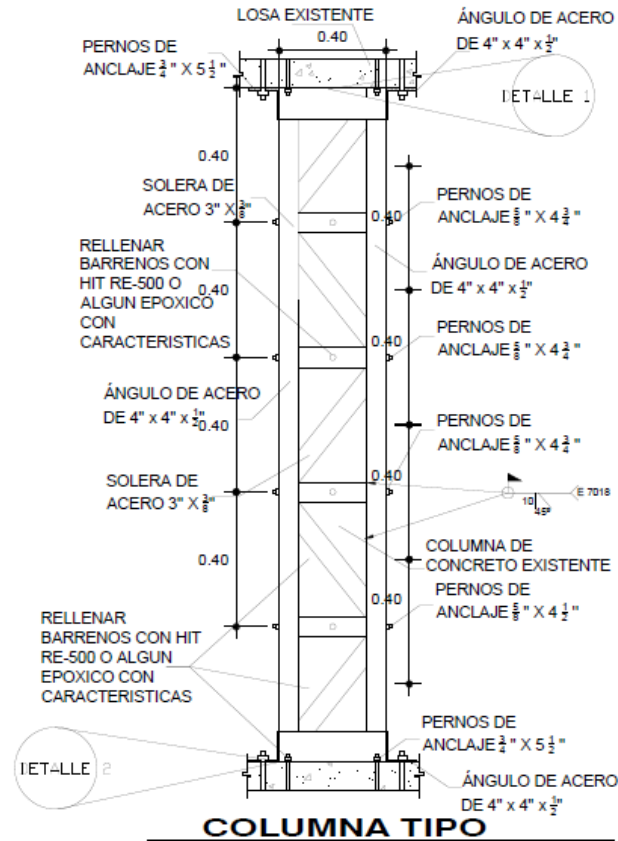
Detalle de refuerzo de columnas de sótano, planta baja, primer y segundo nivel, Proyecto estructural.
